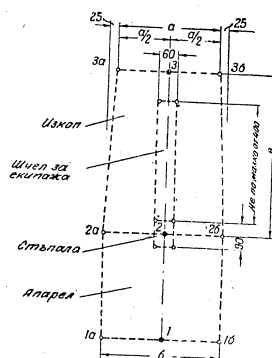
Разбивка на окоп за танк или самоходно-артилерийска установка
